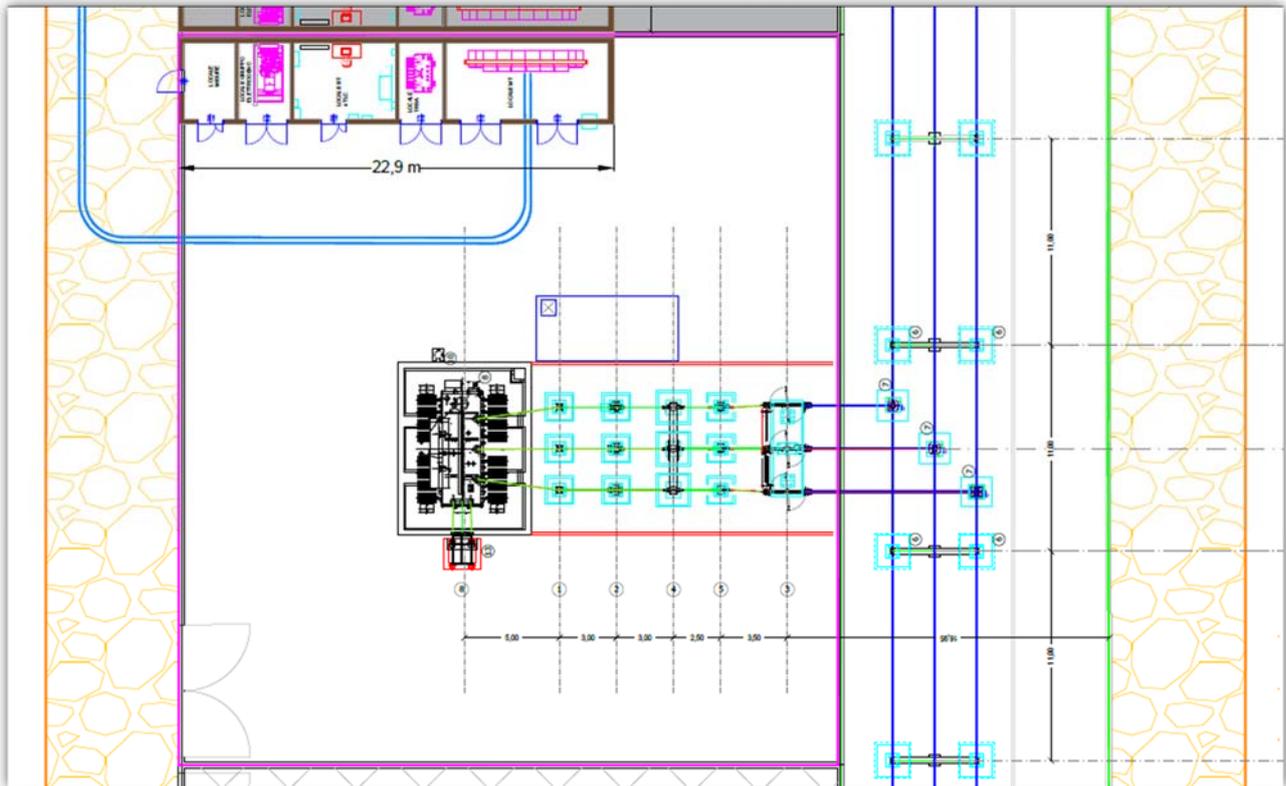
Planimetria elettromeccanica della SSE, con stralcio delle sbarre principali per la condivisione di Stallo.
